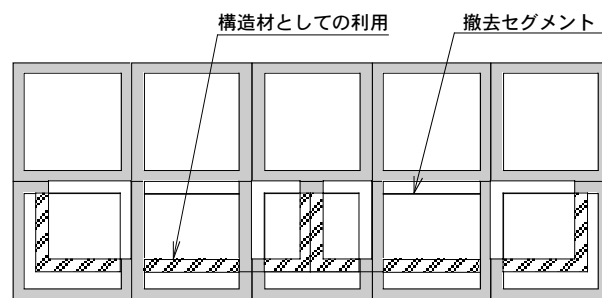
セグメントの再利用例 (床盤コンクリート打設前)
